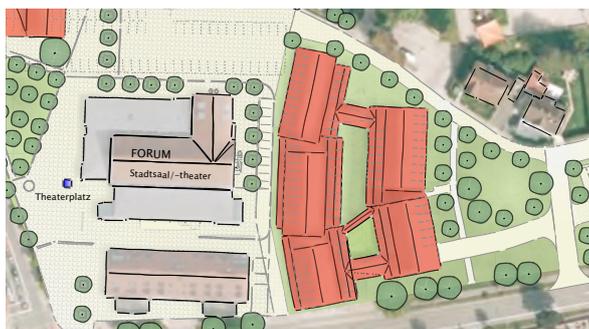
Lageplan / Luftbild Parkhaus Forum - Ost
